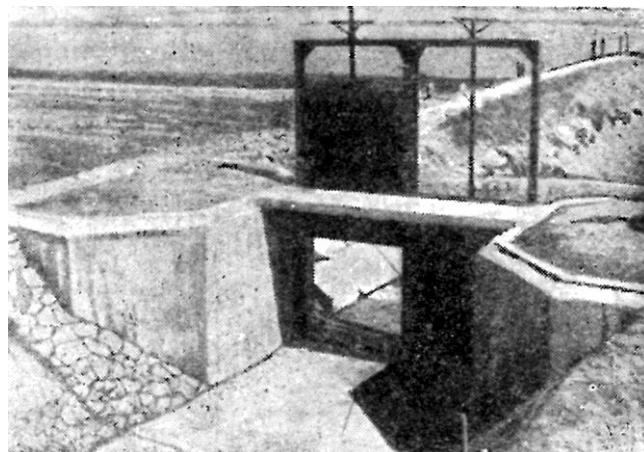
Stăvilă din elemente de beton prefabricate, la sistemul de irigații Domnești
